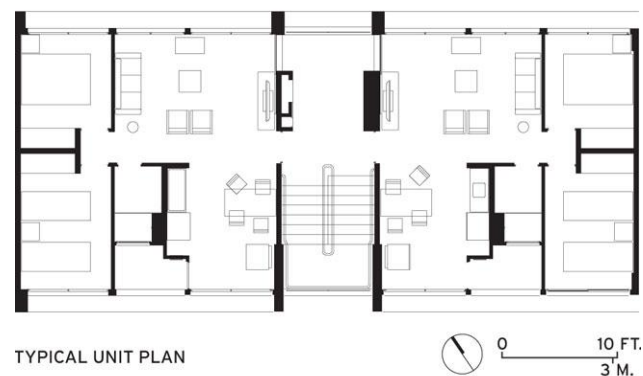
Planta do Bloco de 6 pavimentos. Fonte: Escritório MMBB
